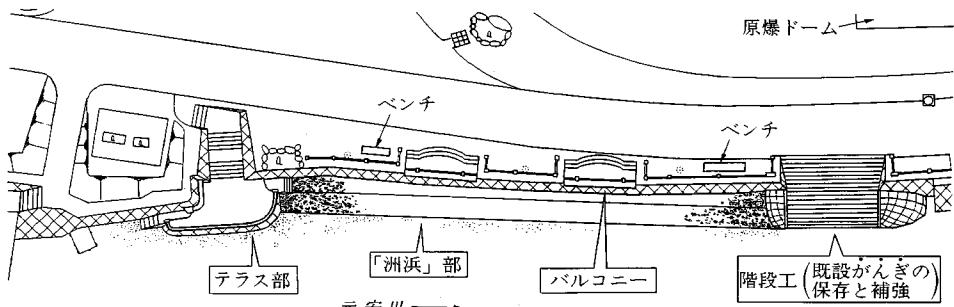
元安川原爆ドーム前親水テラスとバルコニー平面図
